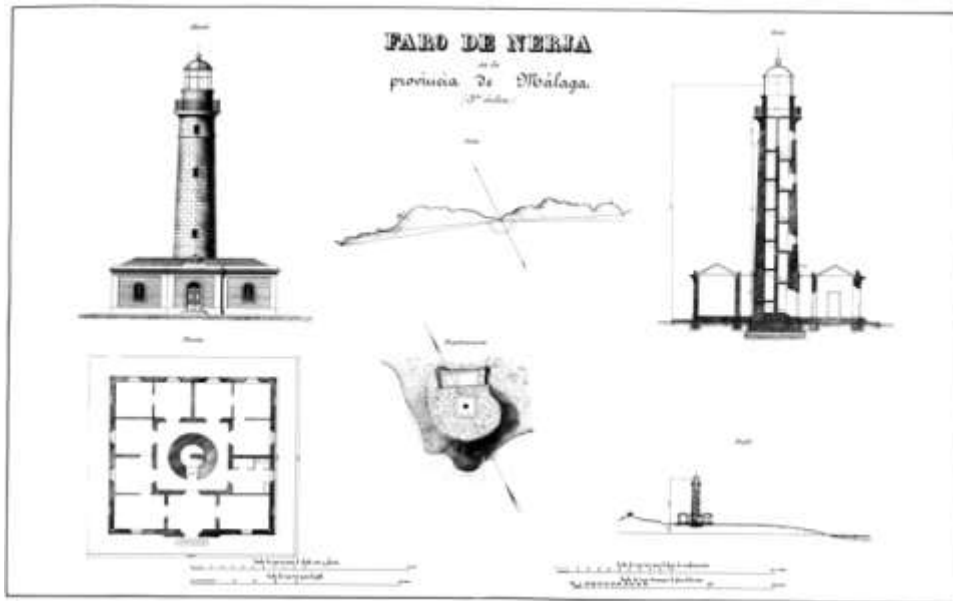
Proyecto de Faro de la Tipología 1, Subtipo A-1
